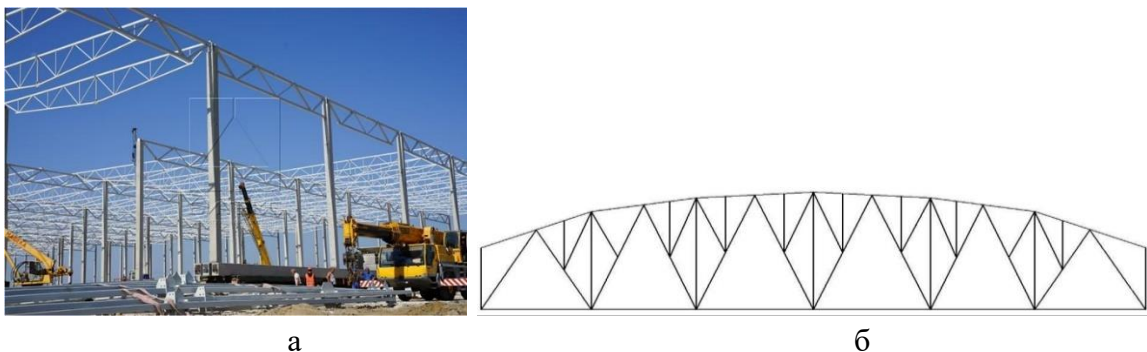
Полігональні ферми: а – збудовані ферми; б – схема ферми
